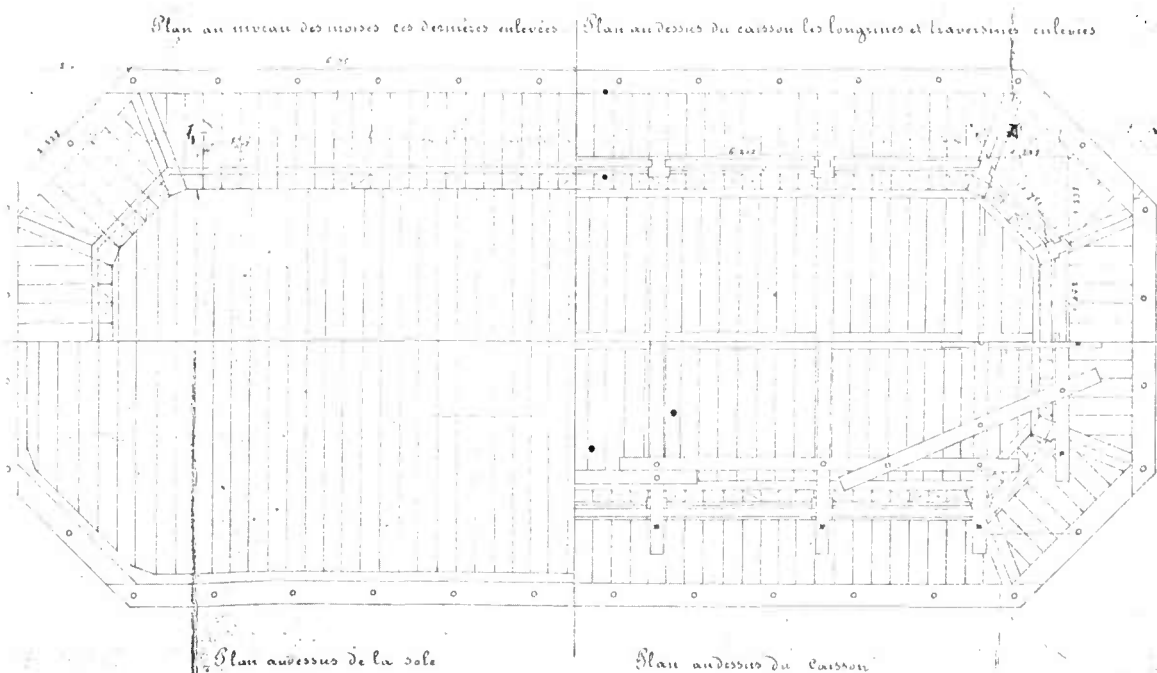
Fondation sur pieux par caisson échoué étanche. Pont Saint-Esprit à Bayonne (milieu du XIX<sup>e</sup> siècle).
